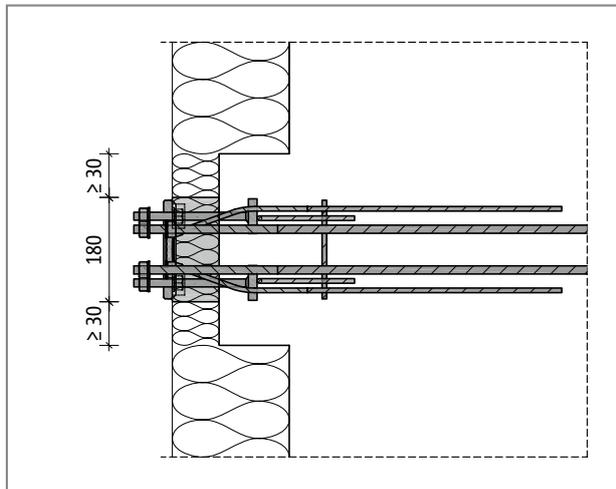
Schöck Isokorb® T Typ SK mit Stahlschwert: Randabstände
